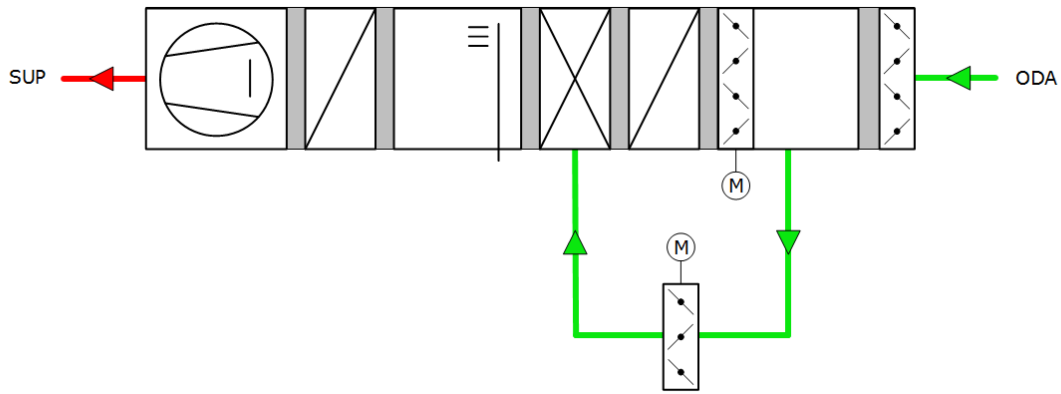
Planungsvariante 2 für den Bau Luft-Bypass, mit zusätzlicher Klappe im Strömungspfad über den Luftkühler
